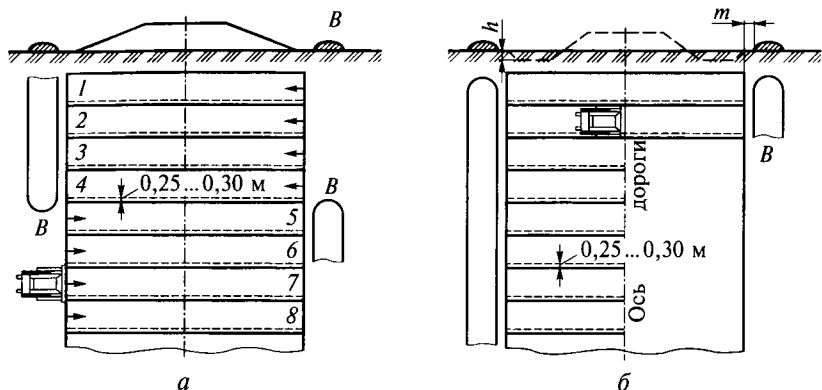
Схема срезки растительного грунта поперечным способом:
